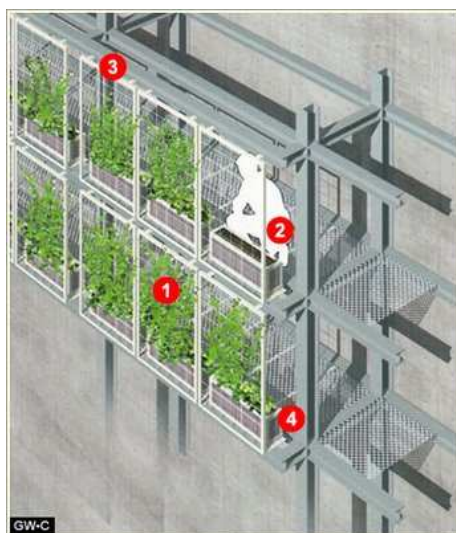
17. Muro vegetal en Doble Fachada tipo Balcón
